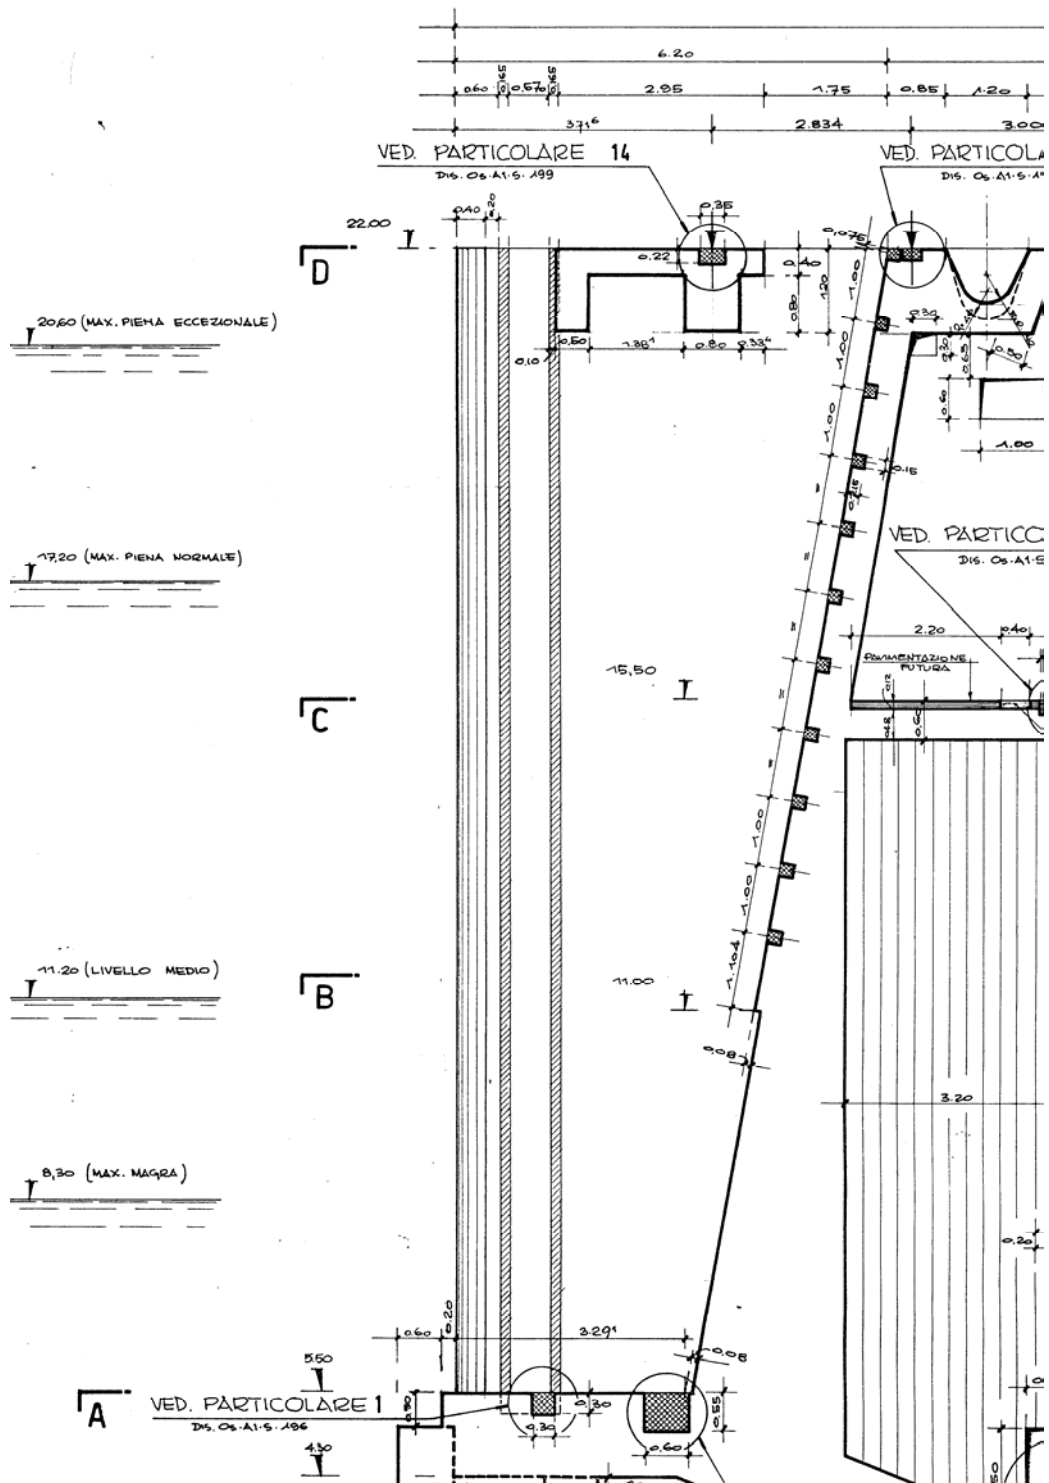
Sezione longitudinale dell'opera di presa nella zona di aspirazione (particolare)
